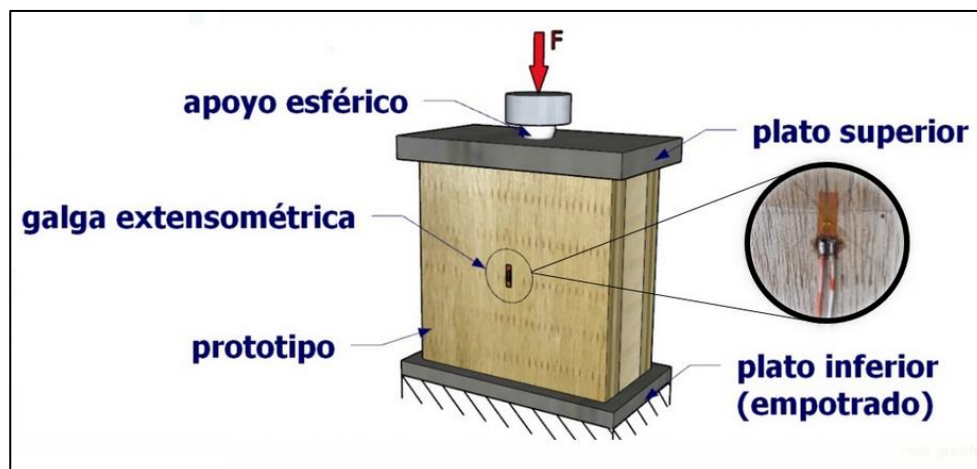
Detalles de la configuración del ensayo a compresión (Galgas extensométricas)
